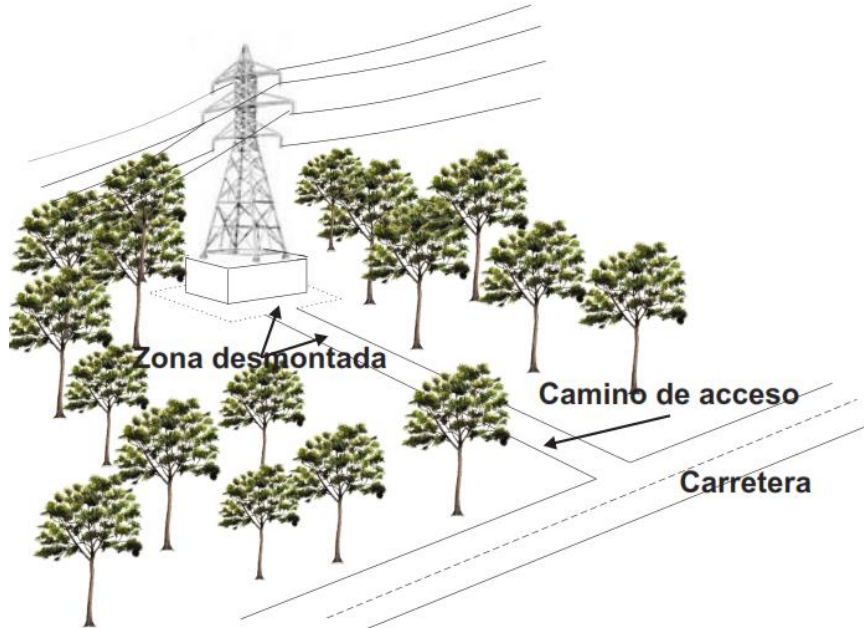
Detalle de construcción de las torres T1 y T2 de la línea de subtransmisión.
